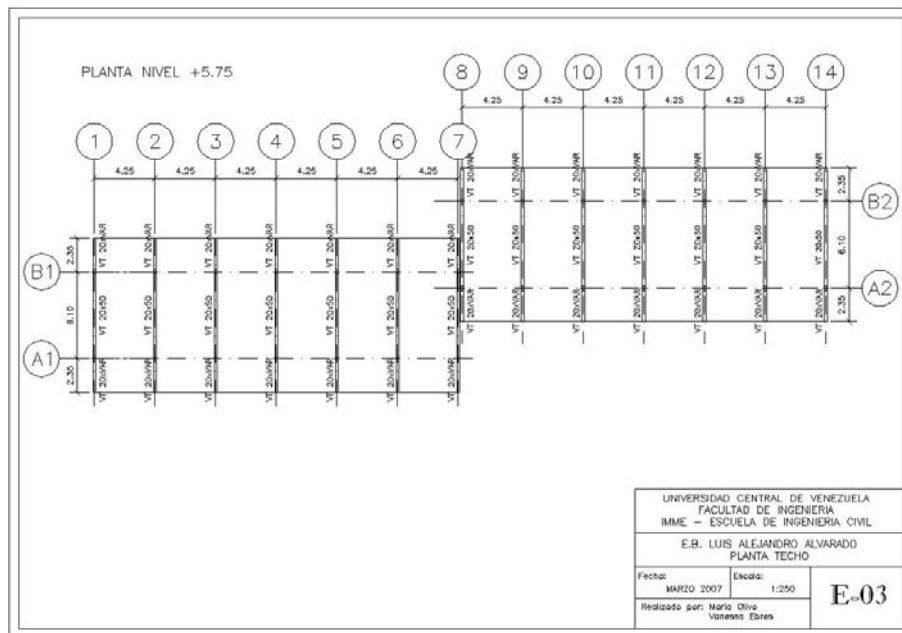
Planta de Envigado Nivel Techo.
